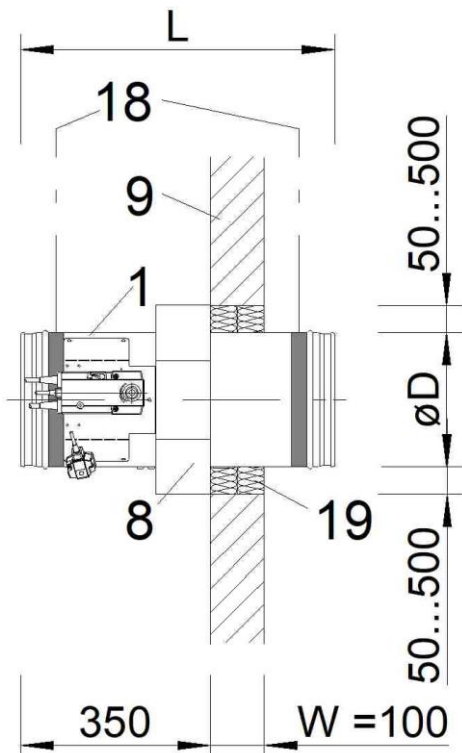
montaggio in parete massiccia (spessore parete = 100 mm)
